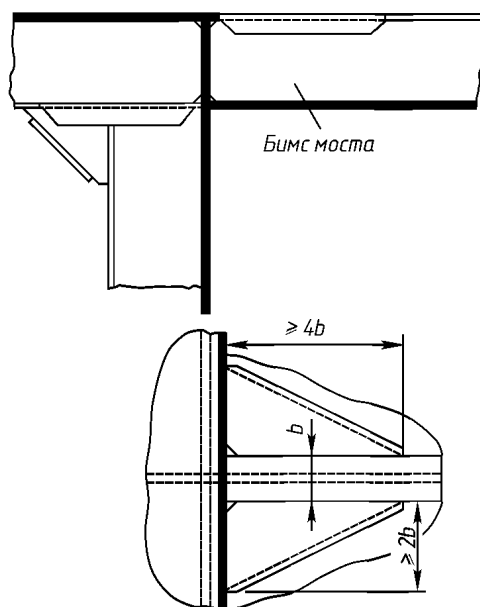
Конструкция соединения полки рамного бимса открытого сверху моста с палубой
